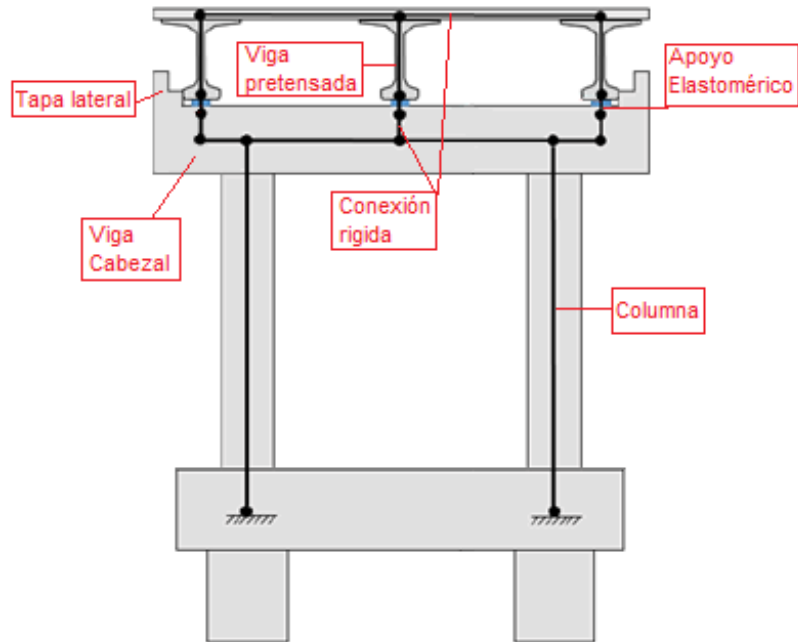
Elevación transversal en cepa, paso inferior Las Mercedes.
